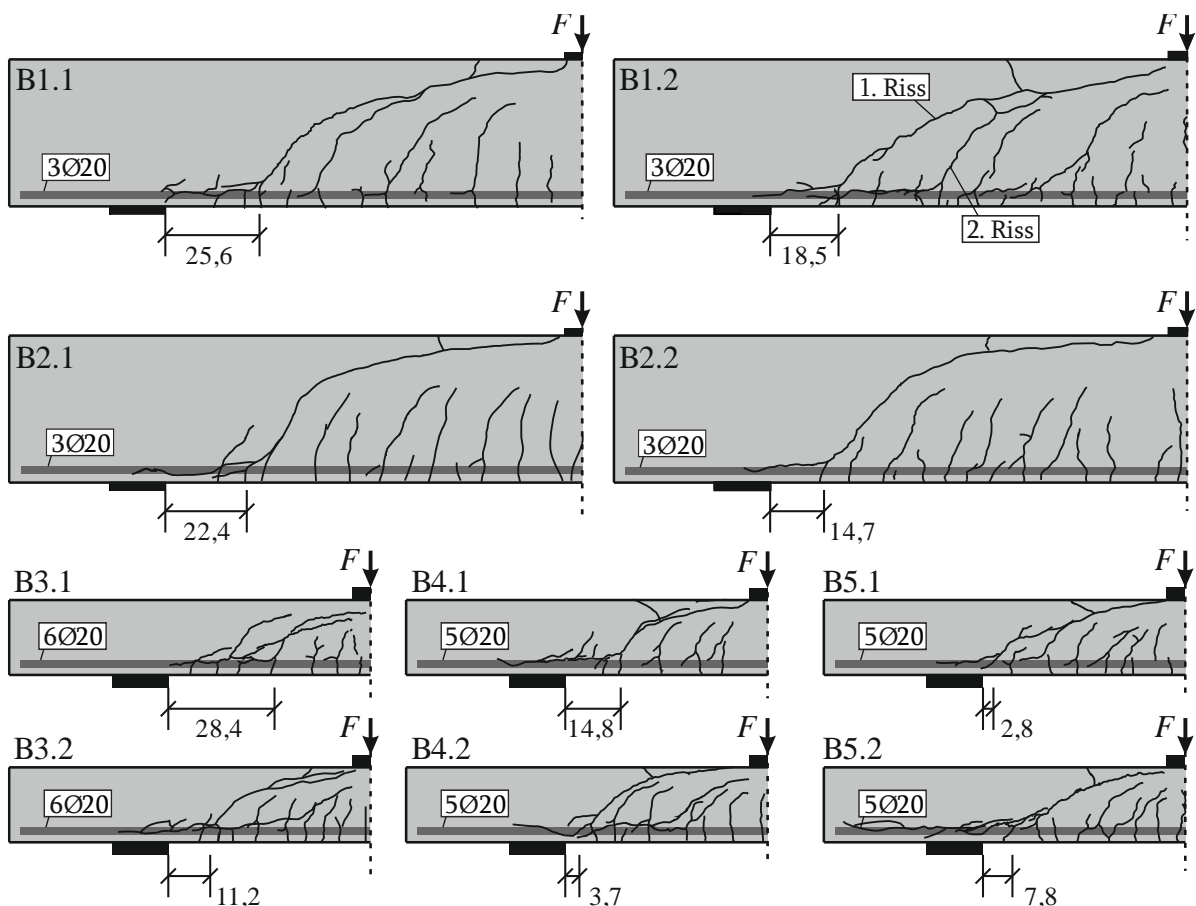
Rissbilder nach dem Versagen der Balken B1 – B5 [63]
